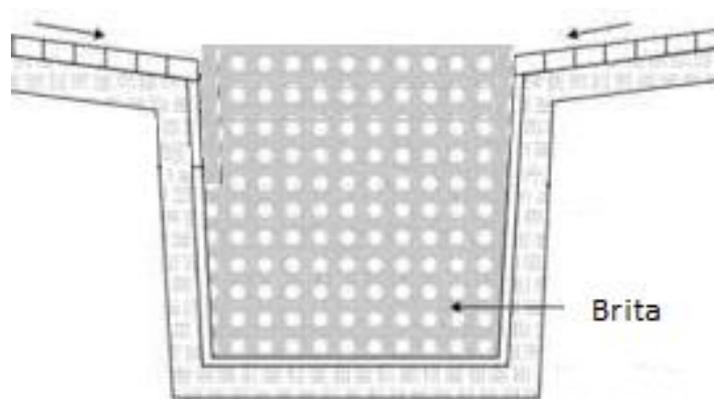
CANALETA DE ALVENARIA COM ENCHIMENTO DE BRICA
